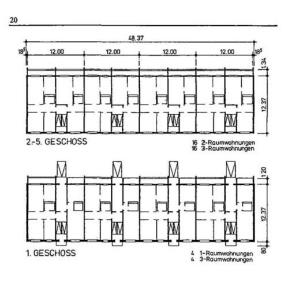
Grundrissbeispiele für WBS 70 5 Etagen
